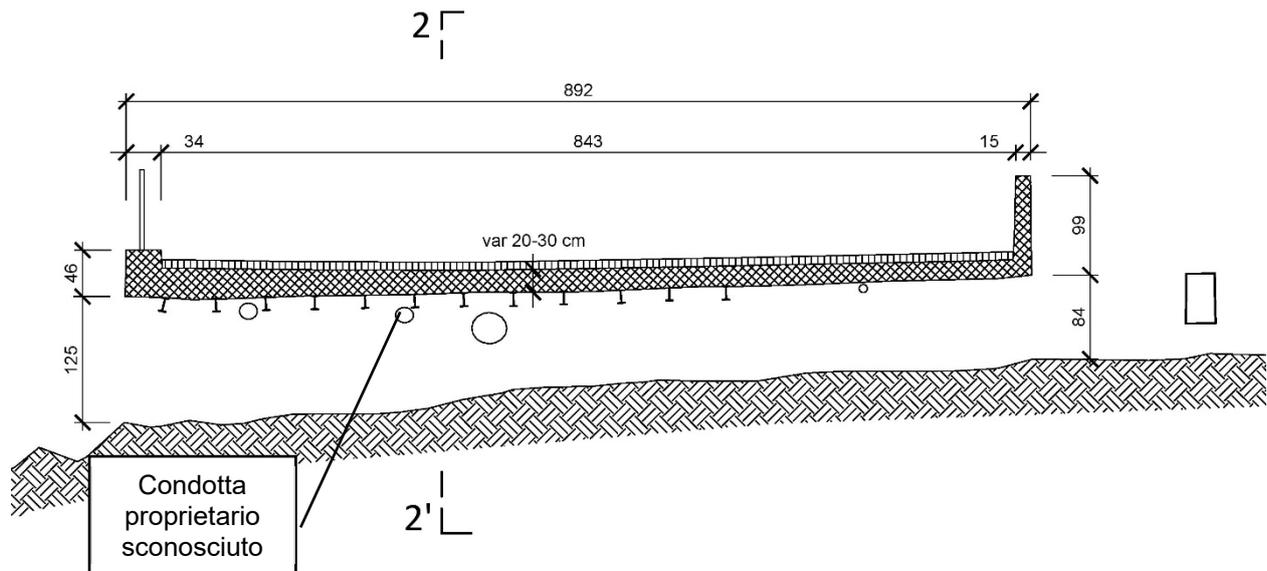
Sezione longitudinale struttura esistente 1-1'
